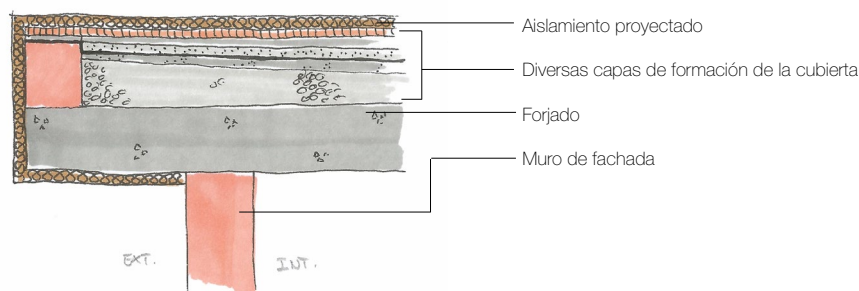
Detalle genérico en sección de aislamiento proyectado en cubierta plana (autoría propia).
